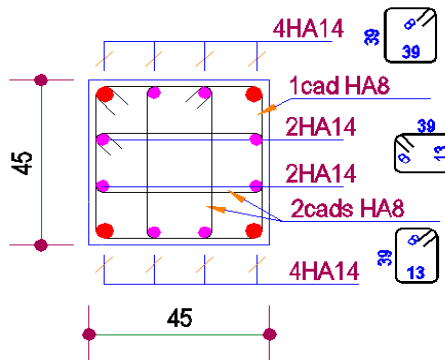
Schéma de ferrailage des poteaux du 8^{ème} étage
